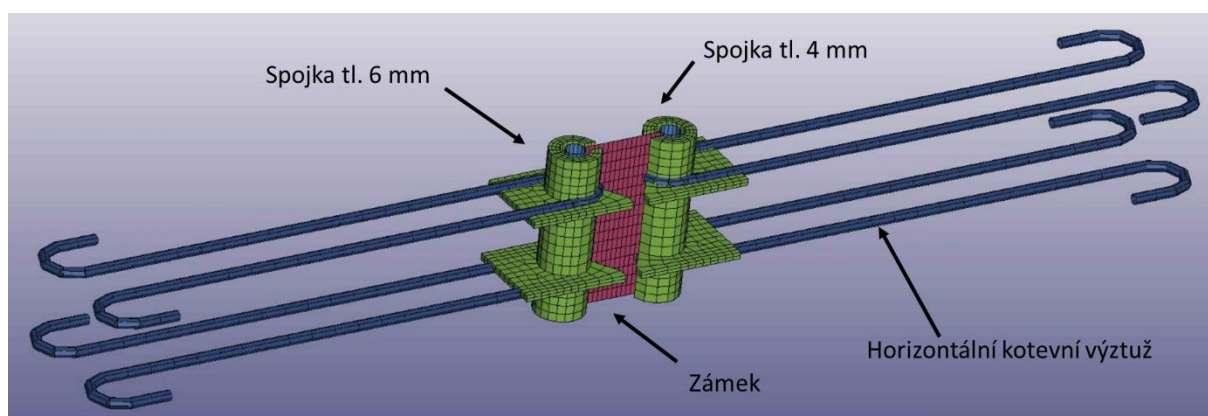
Detail konečněprvkového modelu vyztužení betonových dílců
